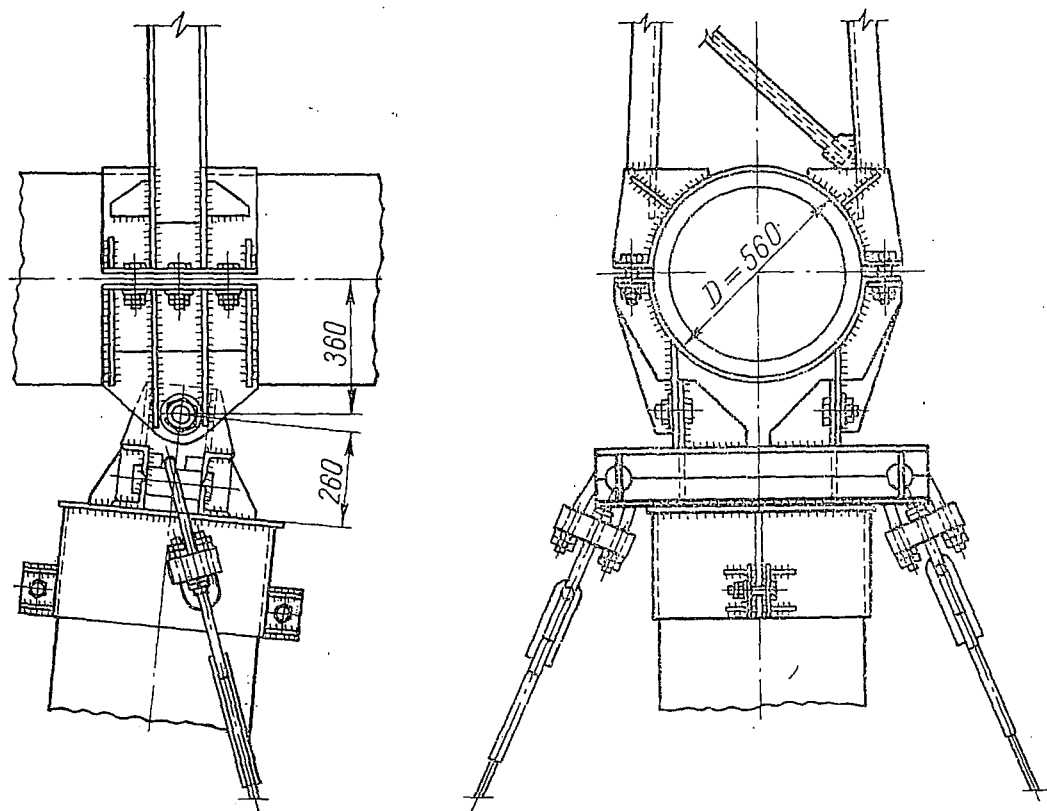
Детали узлов portalной железобетонной опоры на оттяжках
